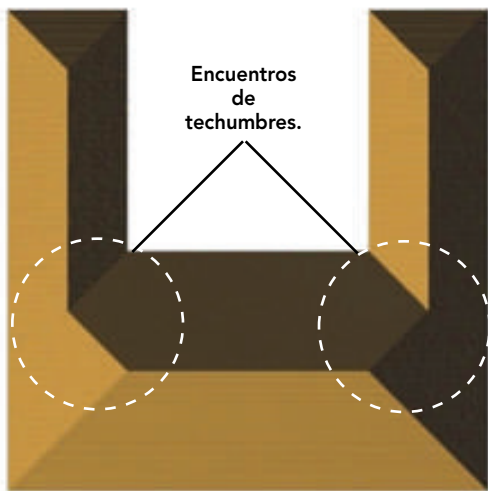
Vista en planta de una techumbre, donde se aprecian dos encuentros de techumbres.
